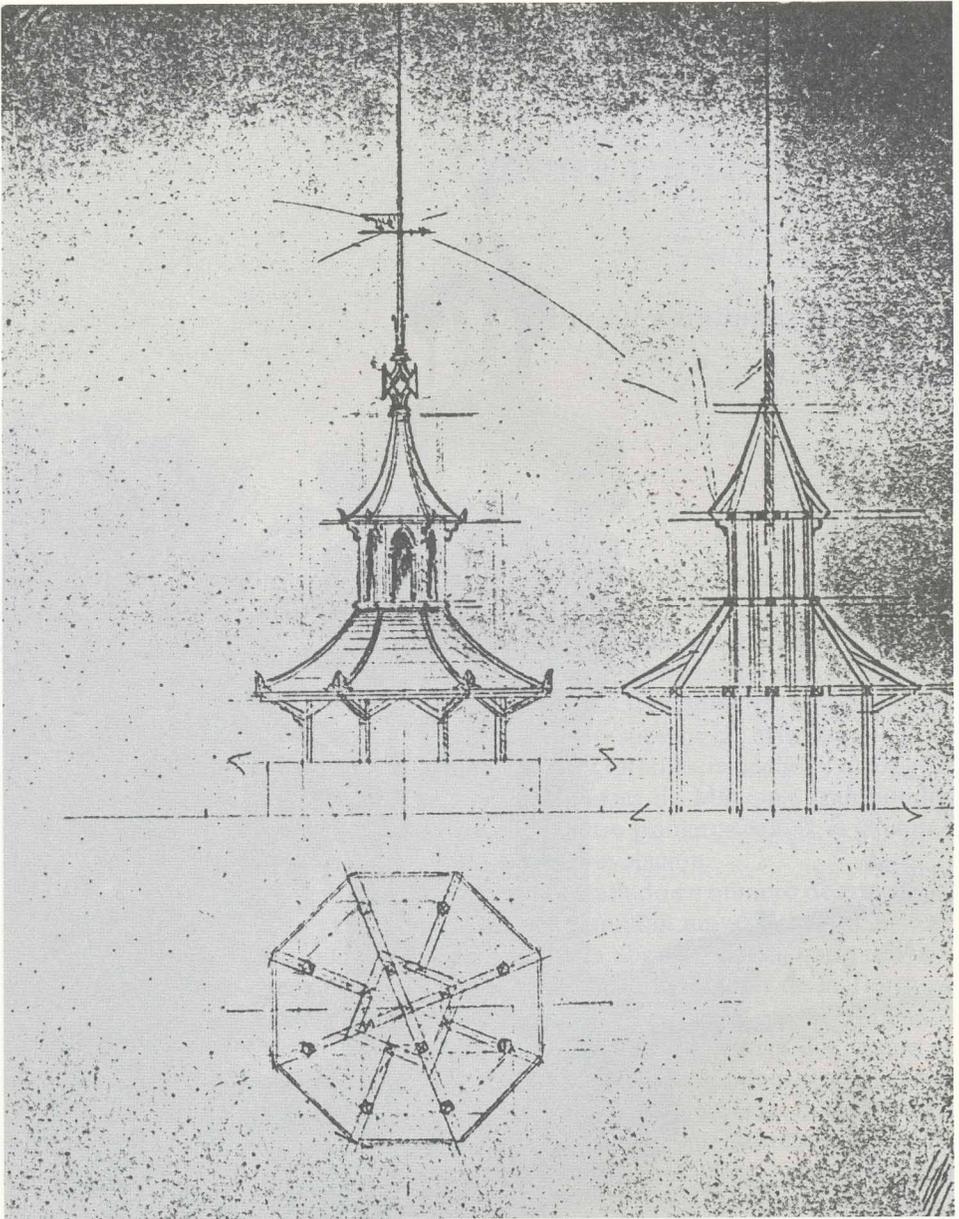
Alzado, sección transversal y longitudinal de la torre, hacia 1894.
